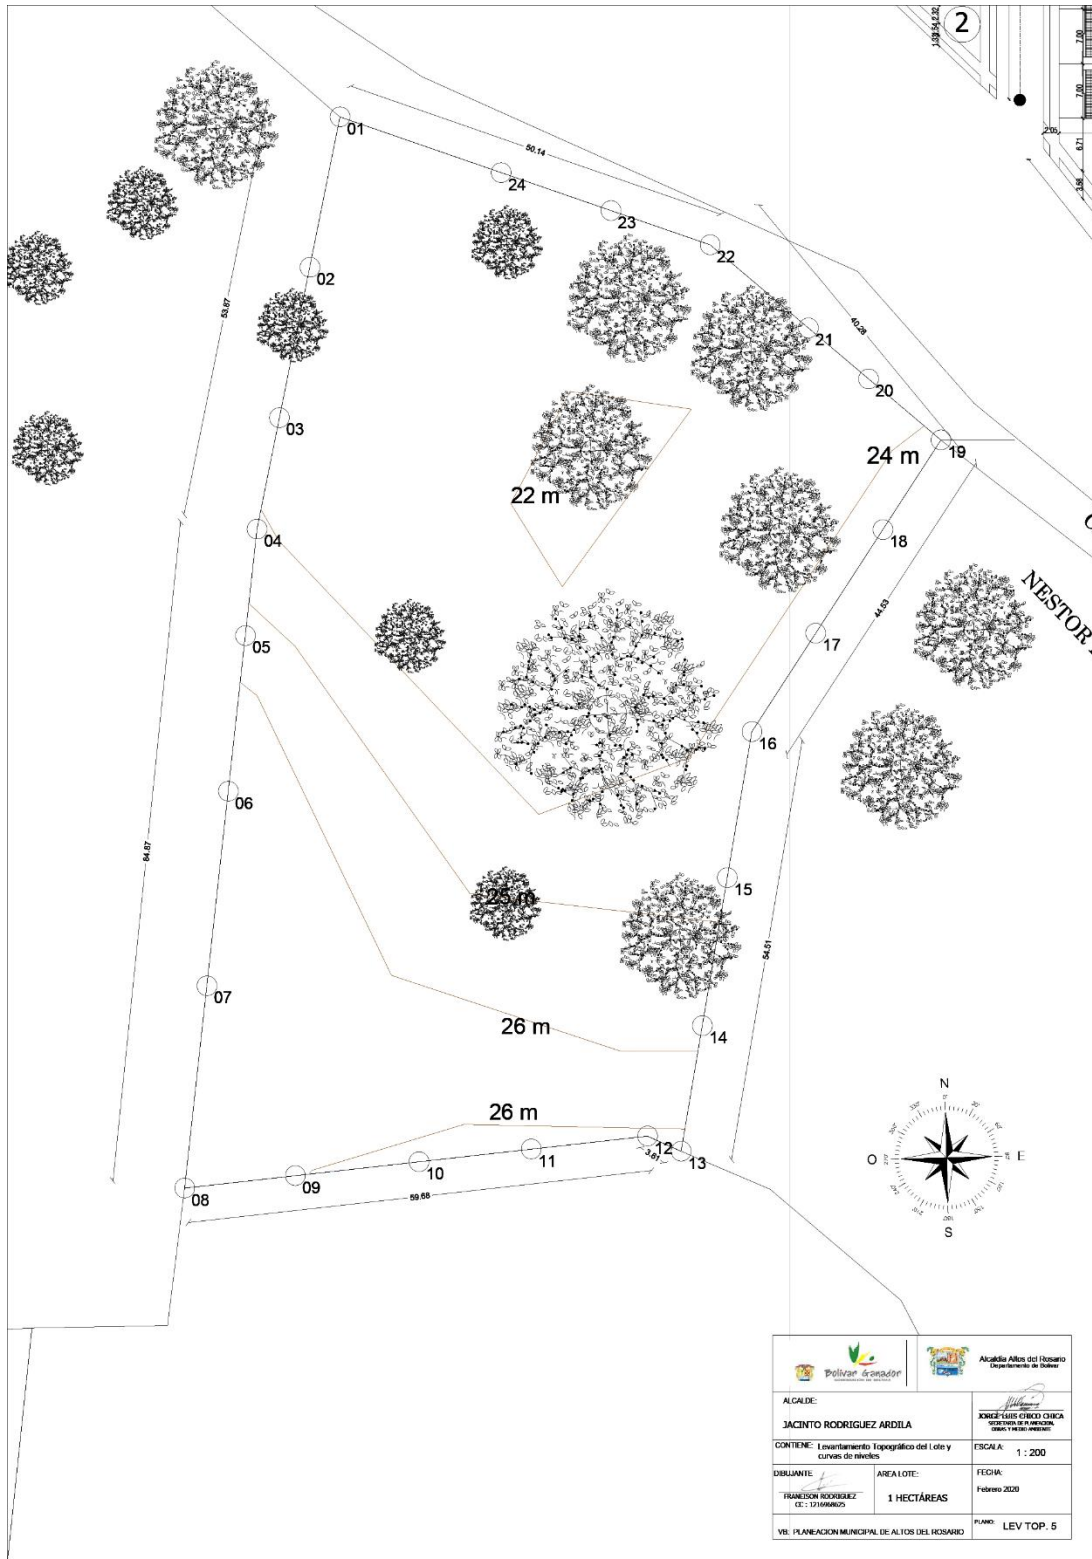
Plano Arquitectónico del levantamiento de los punto de GPS fuente autor
